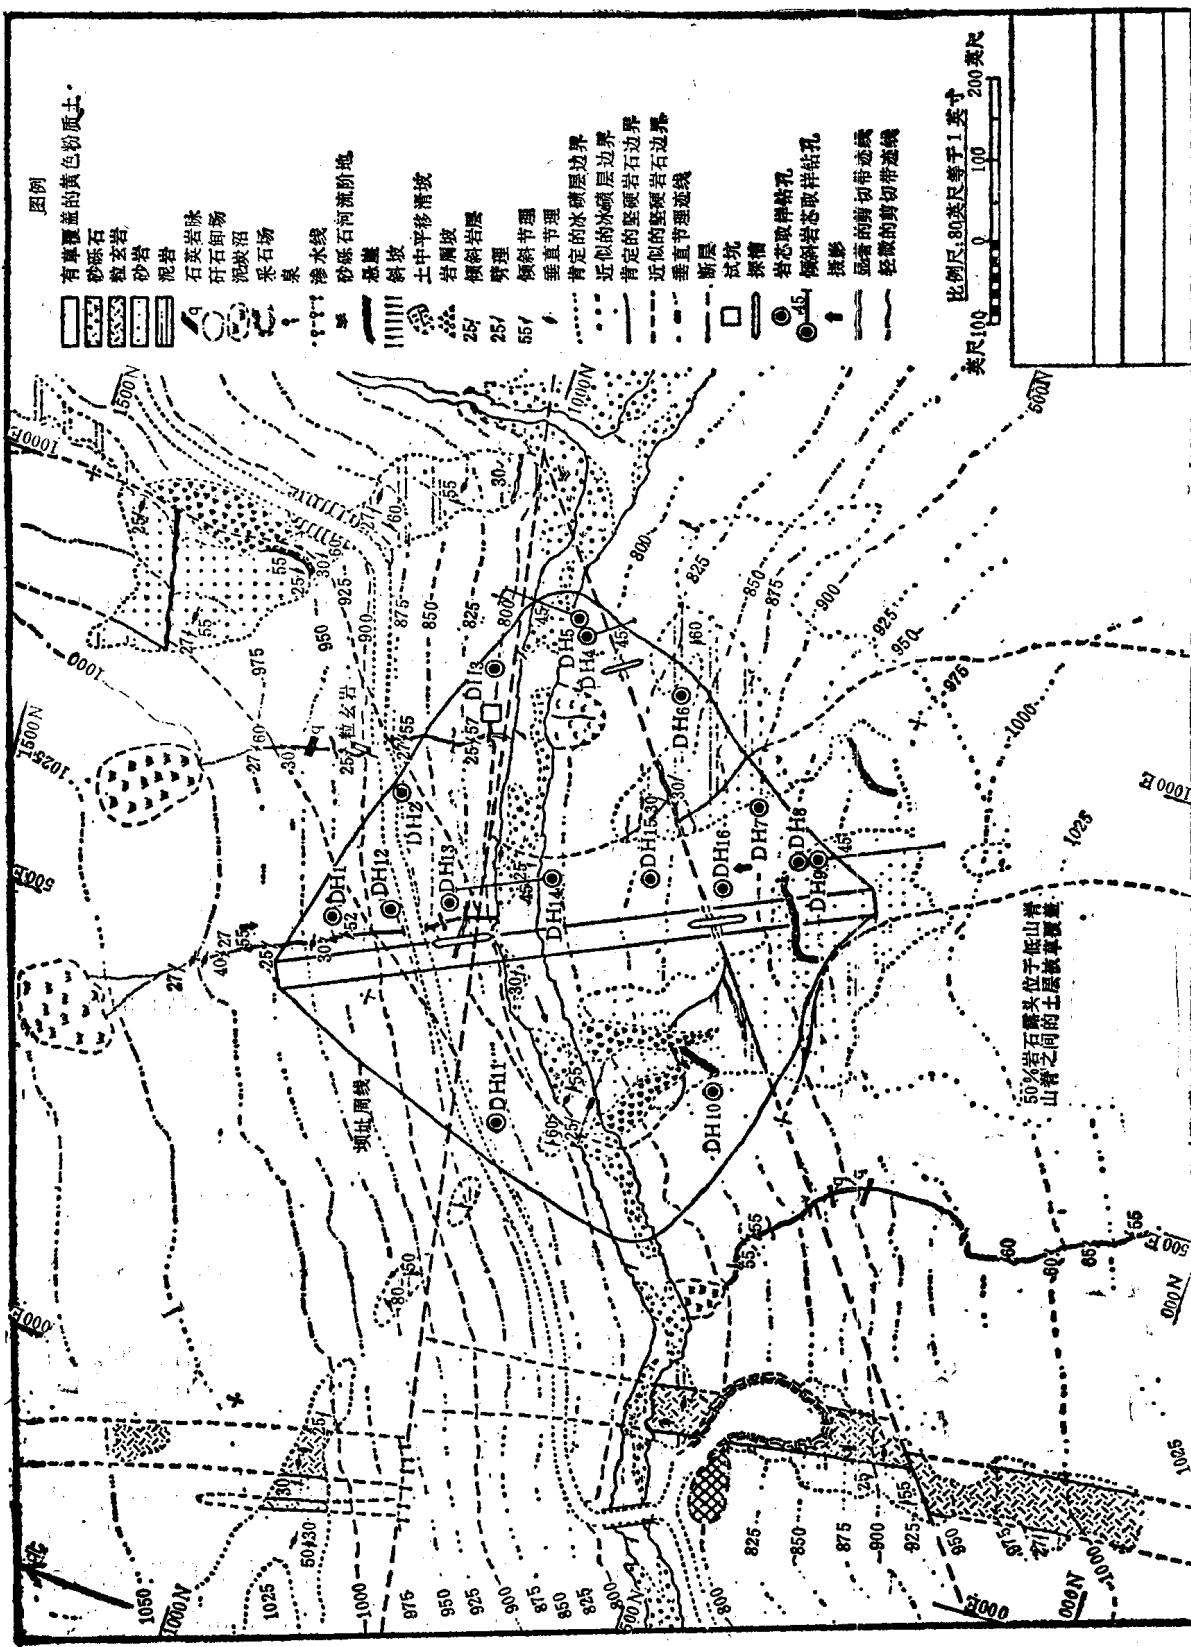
场地勘察平面图 表明详细地质资料的坝址平面图，资料来源于初始的步行勘测和场地勘察使用的钻孔、探槽及探坑
